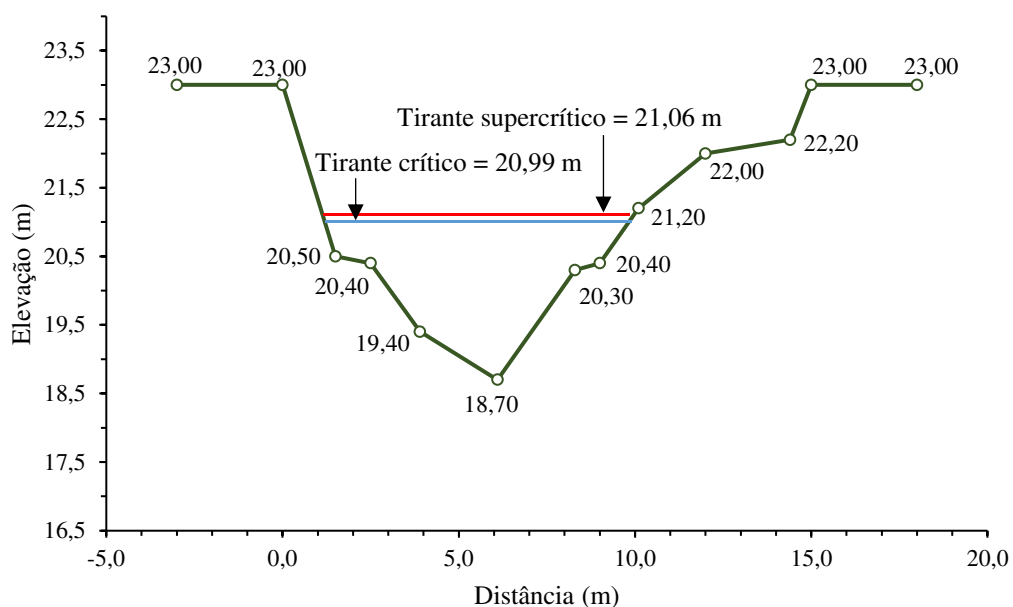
Seção transversal do canal da ponte Santa Cecília 1
